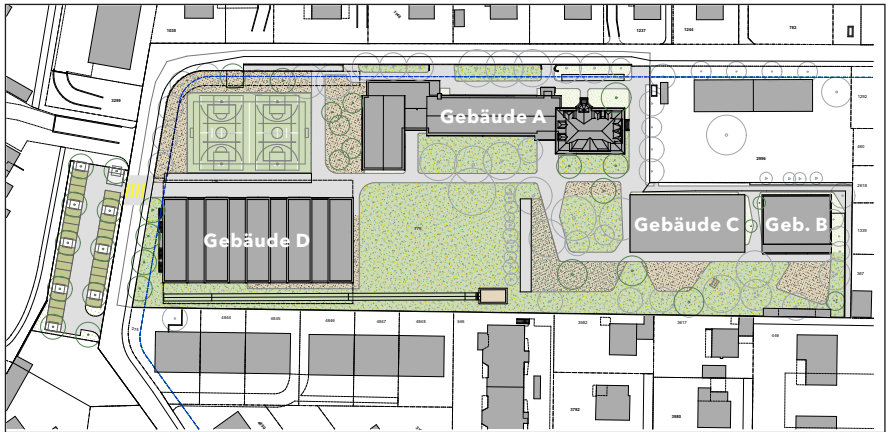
Situationsplan inkl. Umgebung nach Fertigstellung
